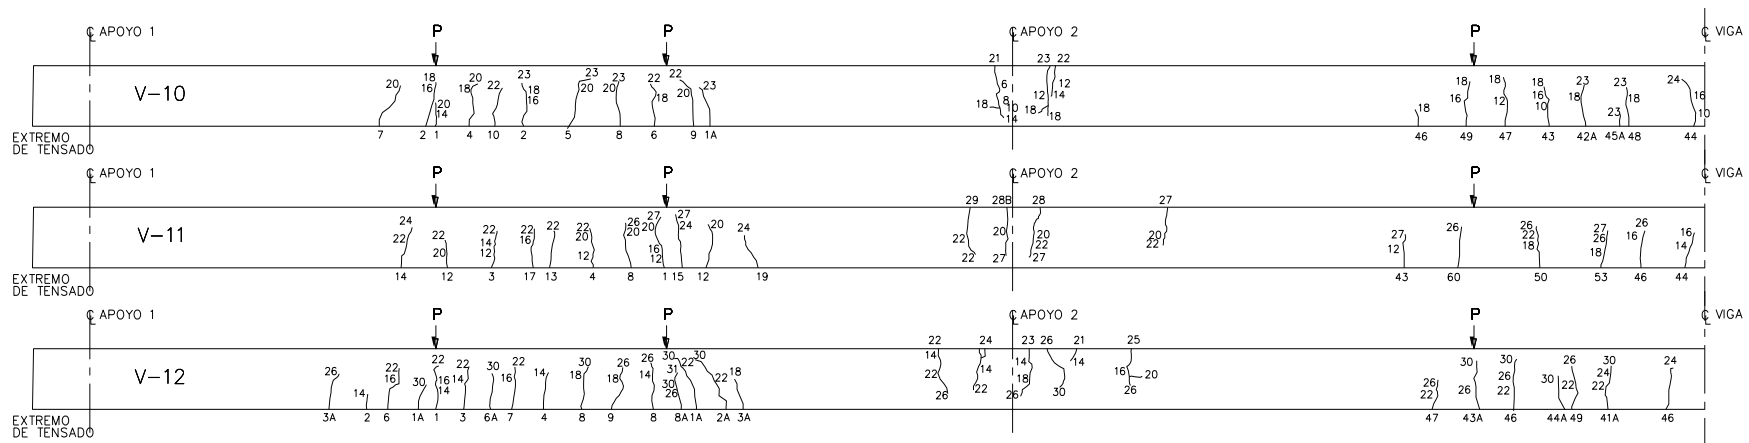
Localización típica de grietas en vigas V-10, V-11 y V-12 (500 x 150 mm). Media elevación lado izquierdo.
